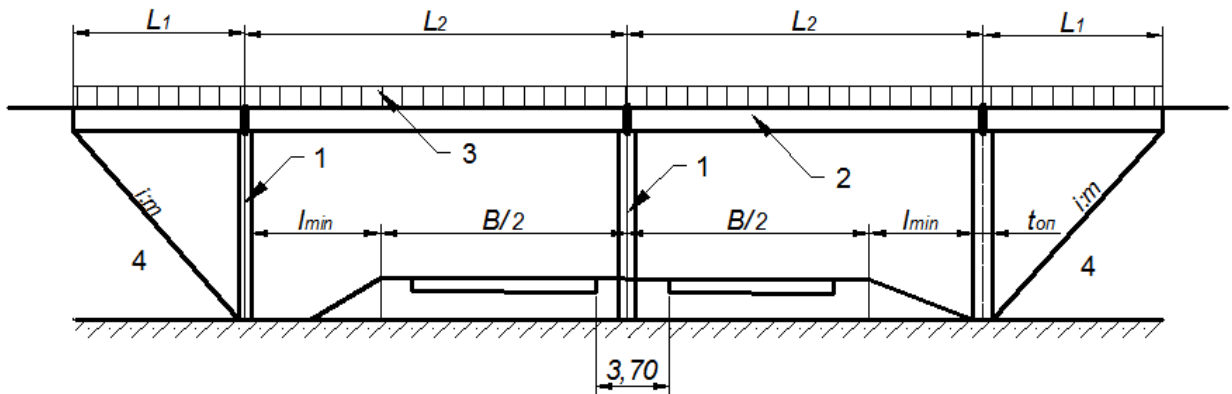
Схема четырехпролетного балочного путепровода: 1 – опора; 2 – пролетное строение; 3 – перила; 4 – конус насыпи.
